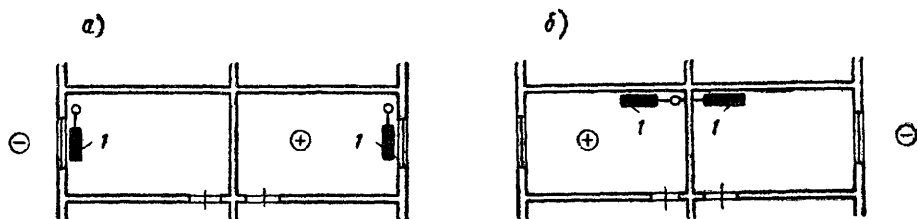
Размещение отопительного прибора 1 в помещении (план)
